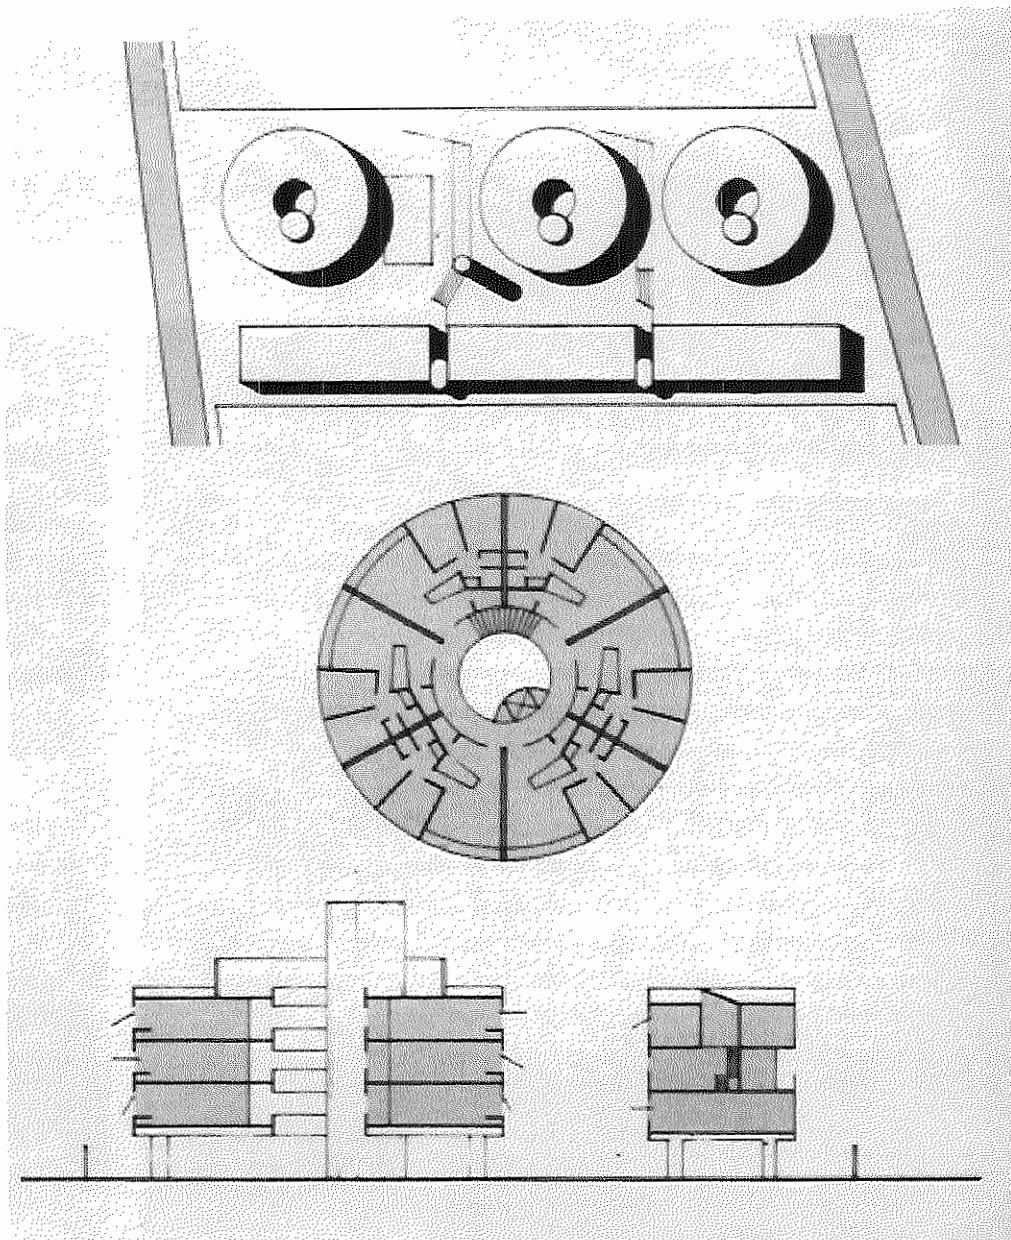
Planta e corte esquemático - Parque Praia Guarujá
